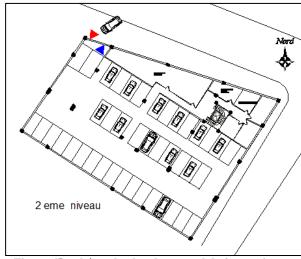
schéma de plan de sous sol de 2 eme niveau.
